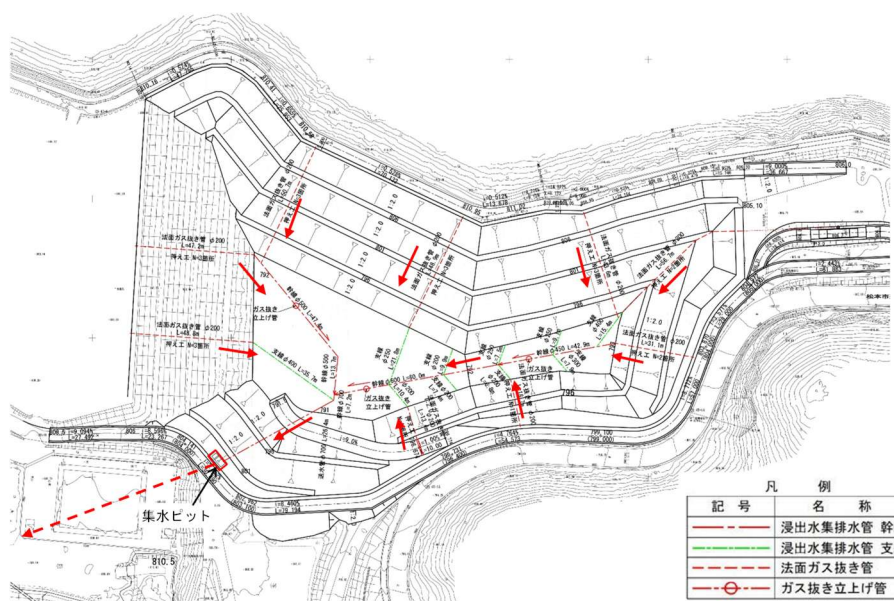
浸出水集排水施設及び埋立ガス処理施設平面図
